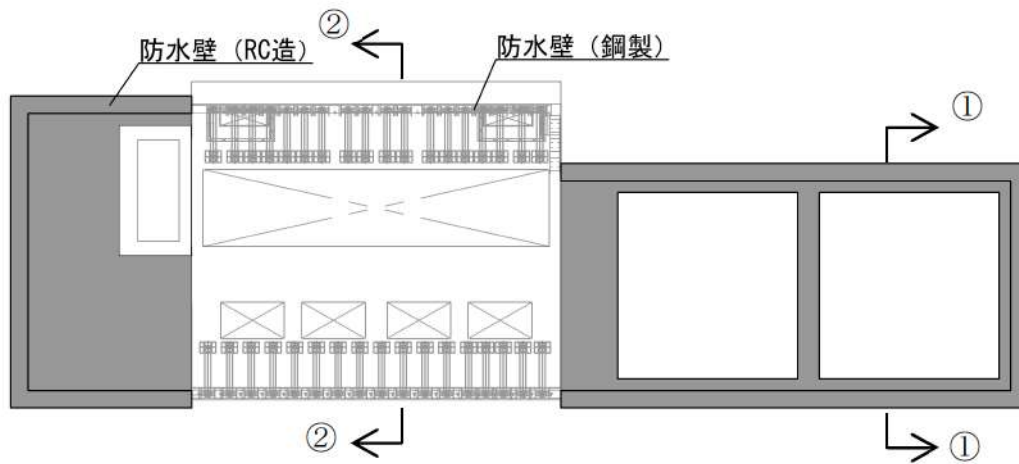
3号炉取水ピットスクリーン室防水壁 平面図
